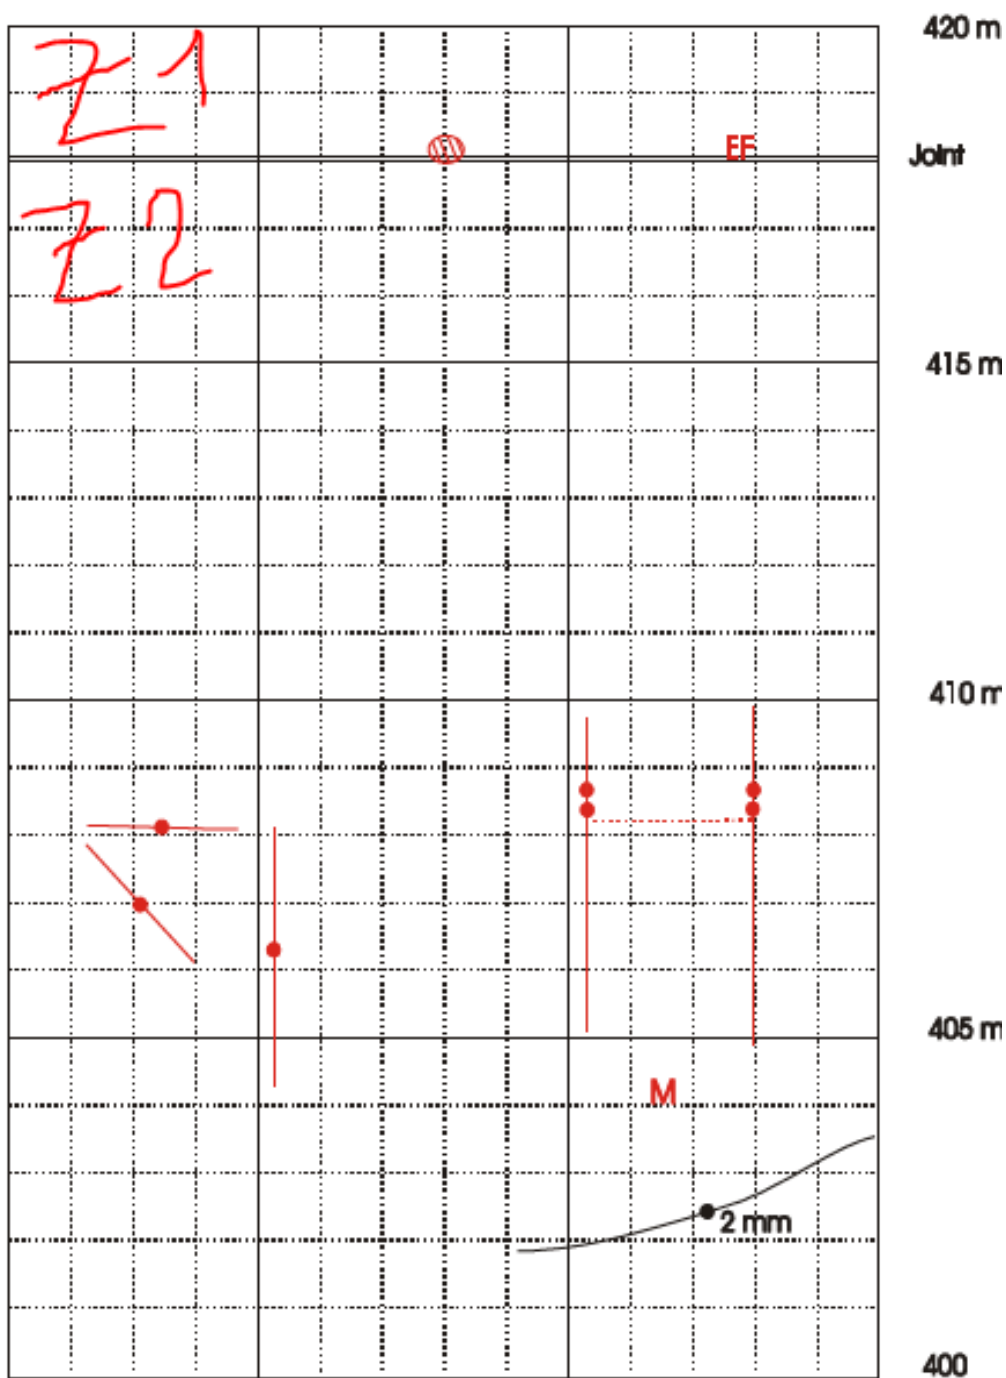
Planche de fissuration travée Sud-Est Zone 2
